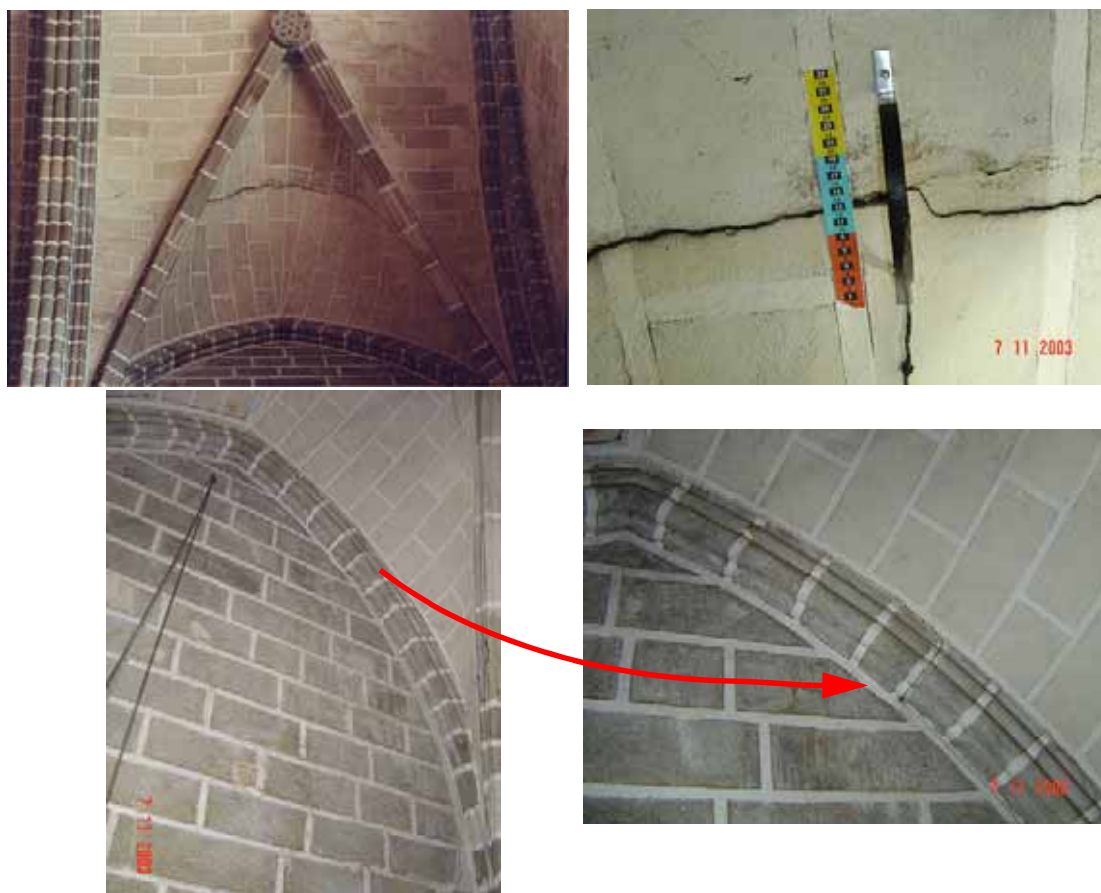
Pormenores da luneta do 1º tramo do lado Sul.
